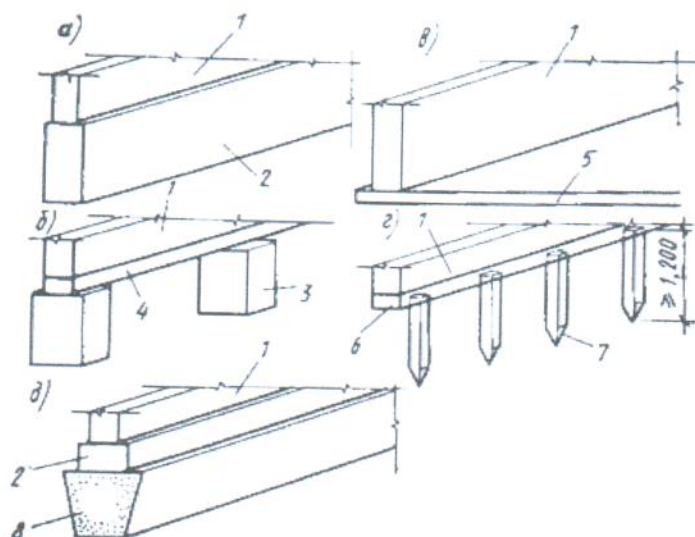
Конструктивные схемы фундаментов малоэтажных жилых зданий:
